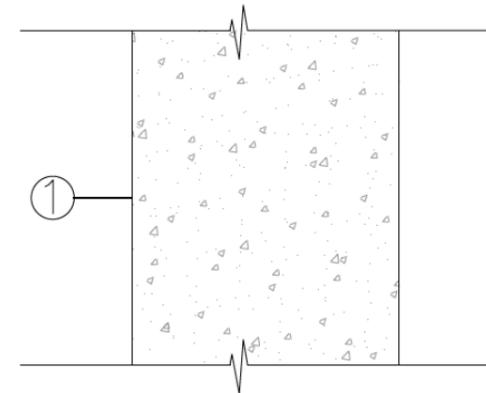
Secció tipus mur de soterrani. Font: Elaboració Pròpia
